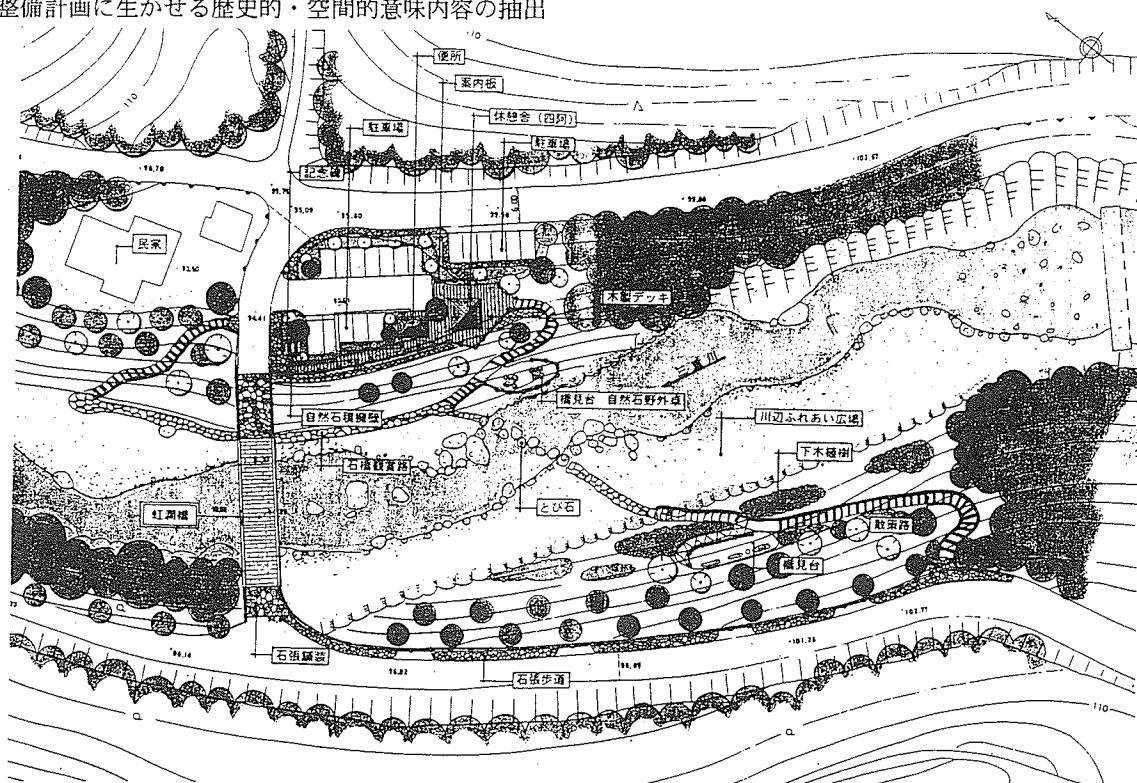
虹潤橋周辺整備計画(案)における整備計画平面図 (縮尺1/500の図を、38%縮小)
